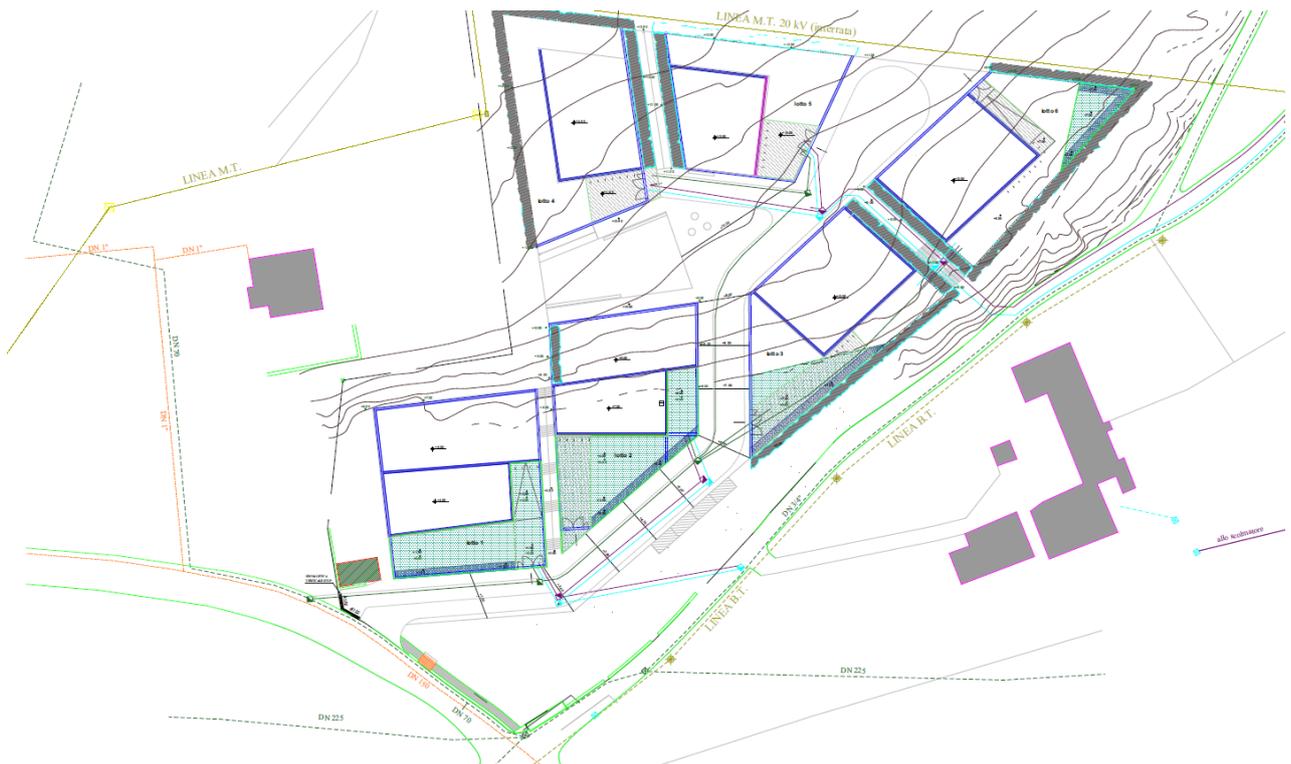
Stralcio planimetria di progetto – individuazione reti idrica e fognaria
